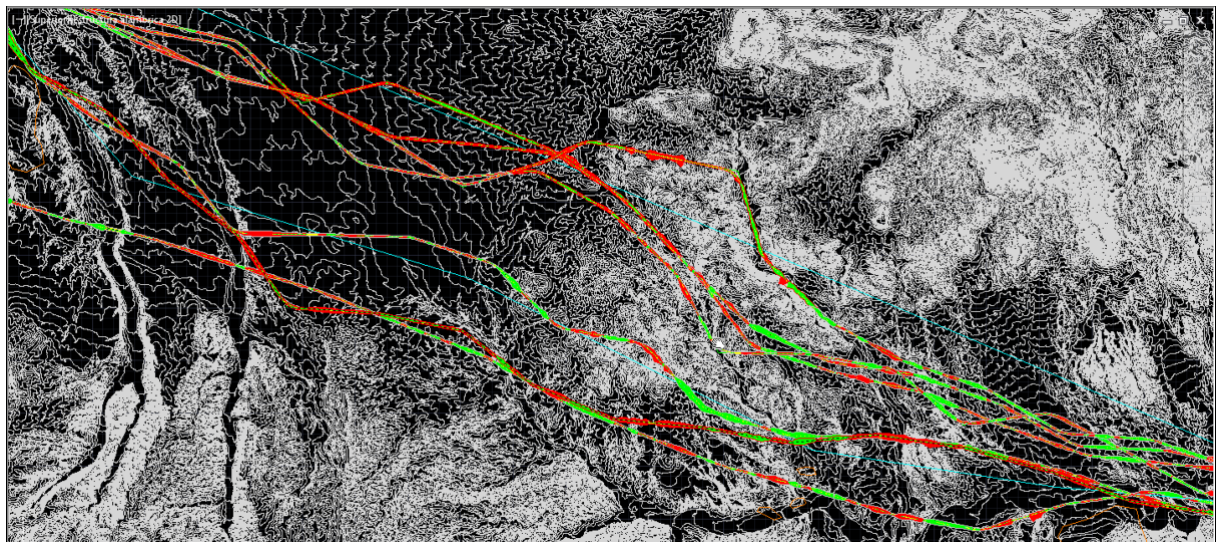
Detalle de la planta de las seis alternativas con solución.
